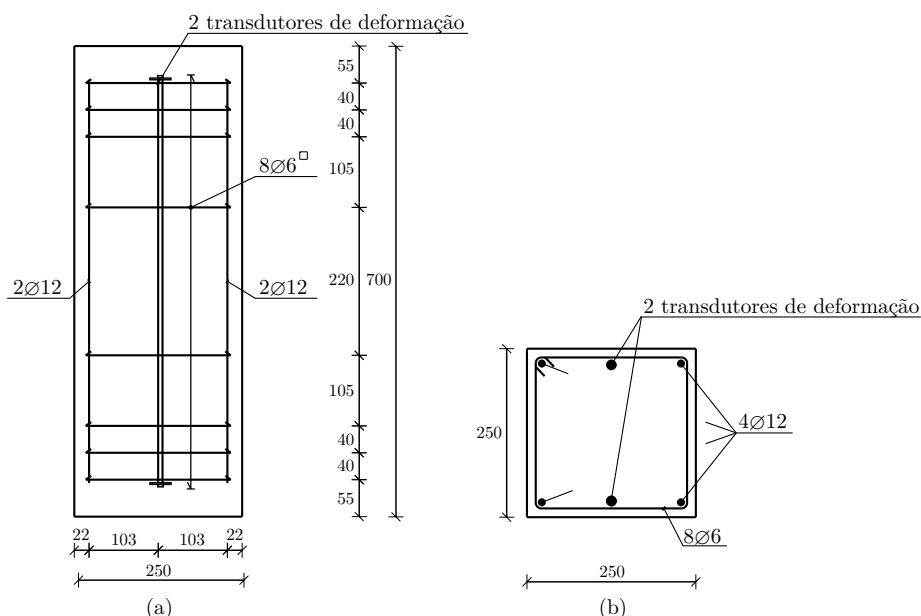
Geometria e armadura do provete de betão  $250 \times 250 \times 700 \text{ mm}^3$ : a) vista em corte por plano vertical; b) vista em corte por plano horizontal (nota: dimensões em mm).
